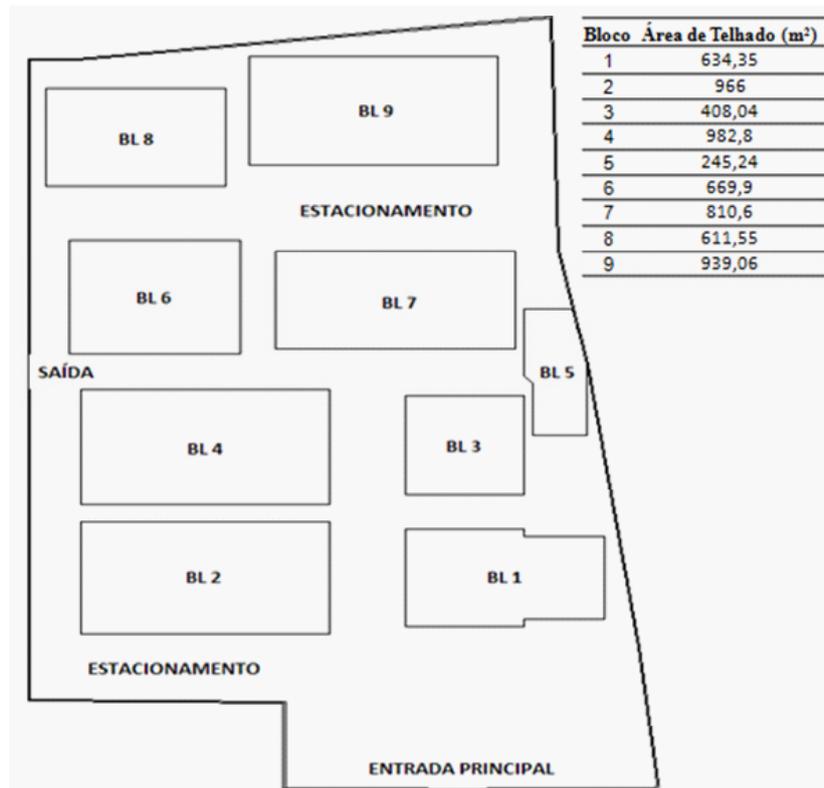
Planta de situação do campus da Universidade Severino Sombra com a distribuição dos blocos e suas áreas de telhado.
